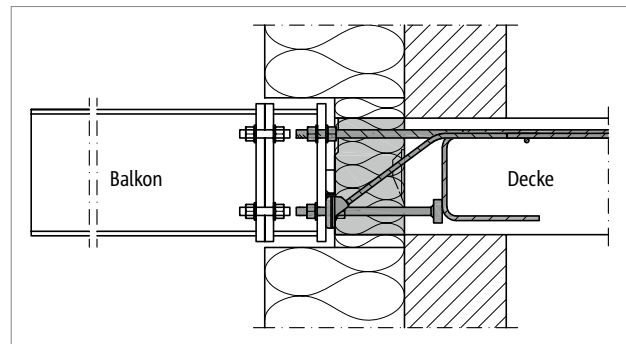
Schöck Isokorb® XT Typ SK: Anschluss des Stahlträgers an einen Adapter, der die Dicke der Außendämmung ausgleicht
